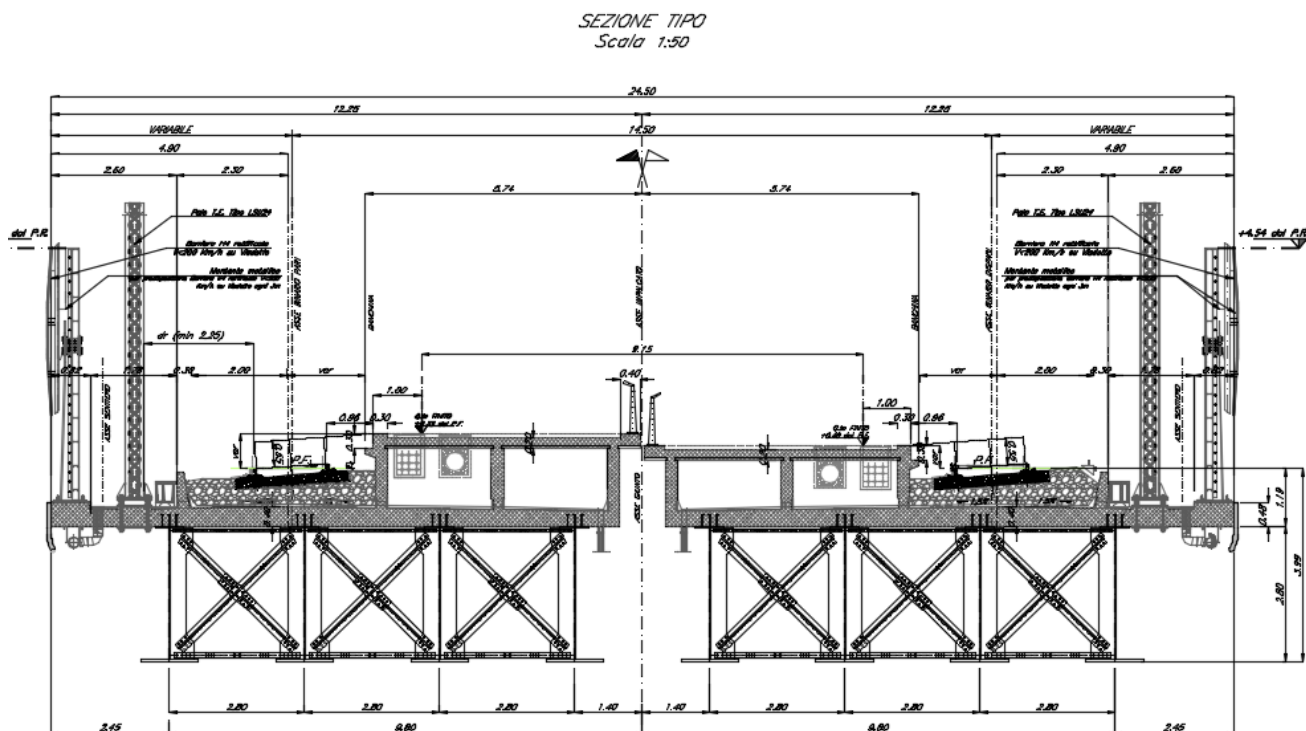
Viadotto Itala Scaletta: sezione trasversale e prospetto binario pari
